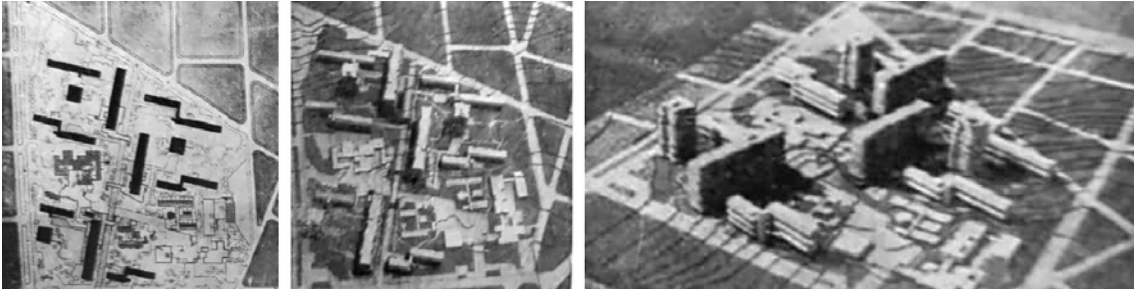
Primer premio (Chao, Daners, Gilboa, Mato y Reverdito) del Piloto 70 en Revista N°8 de la Facultad de Arquitectura.
